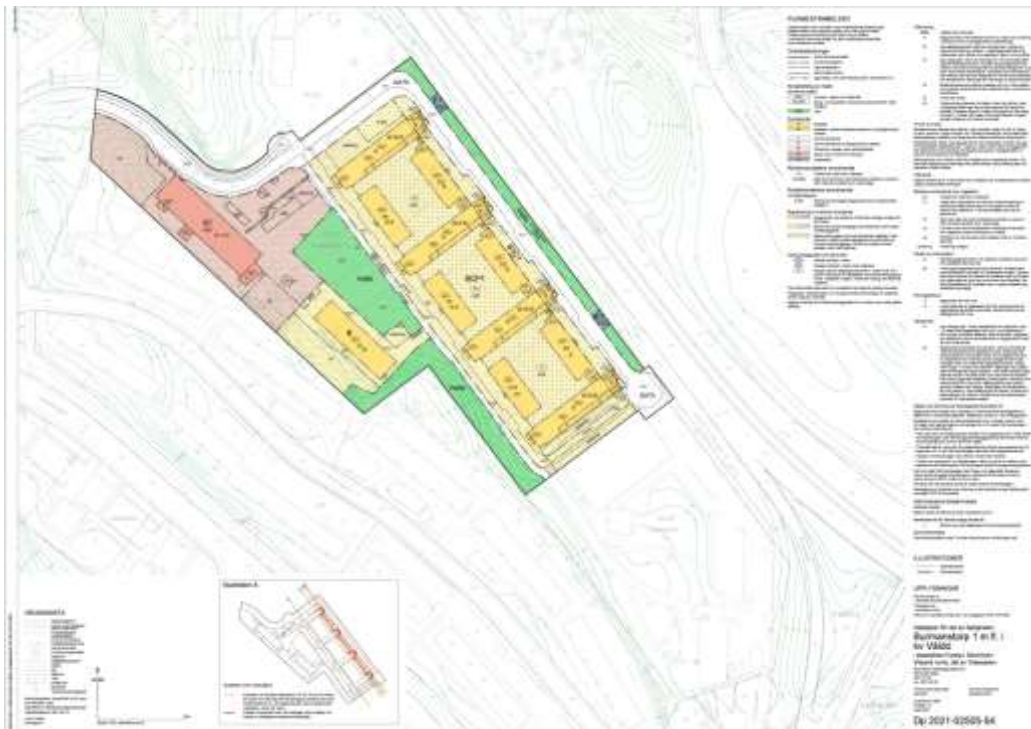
Planerad utformning av Telestaden, bild framtagen av White Arkitektur.
